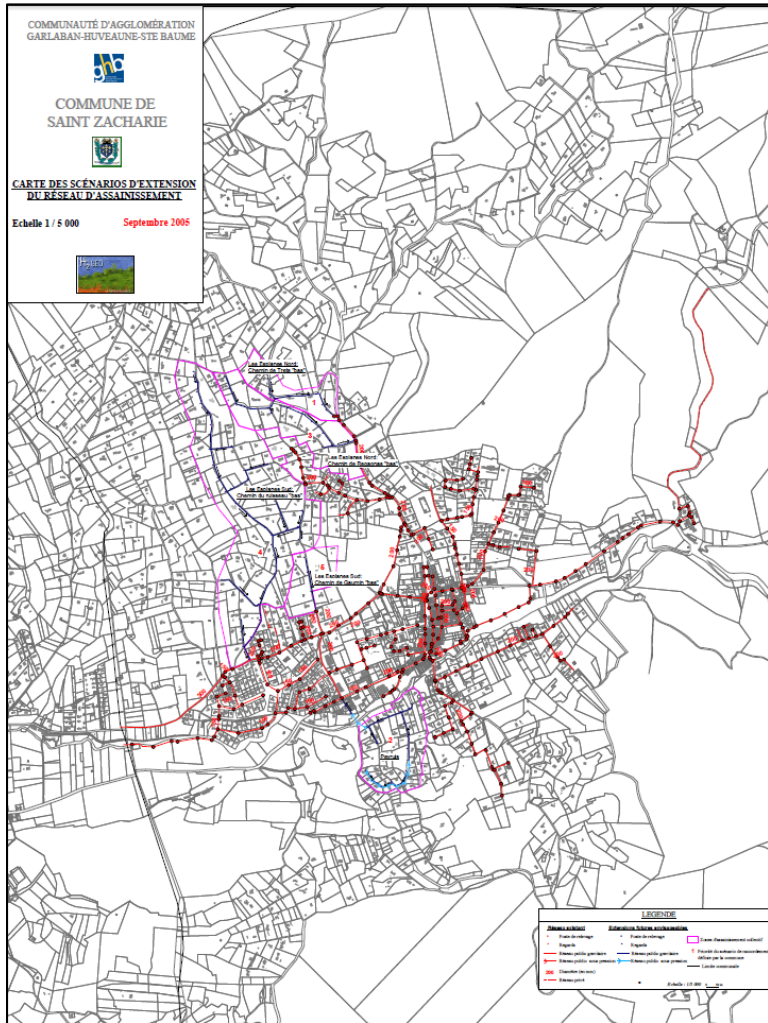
Plan de situation de la collecte – Saint-Zacharie
